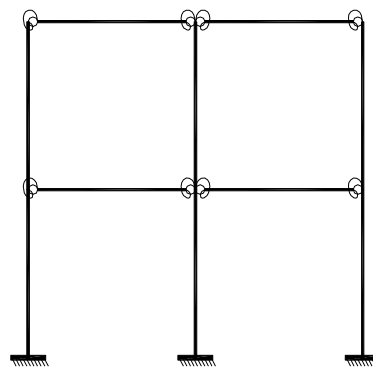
Расчетная схема рамы с упругоподатливыми узлами.
